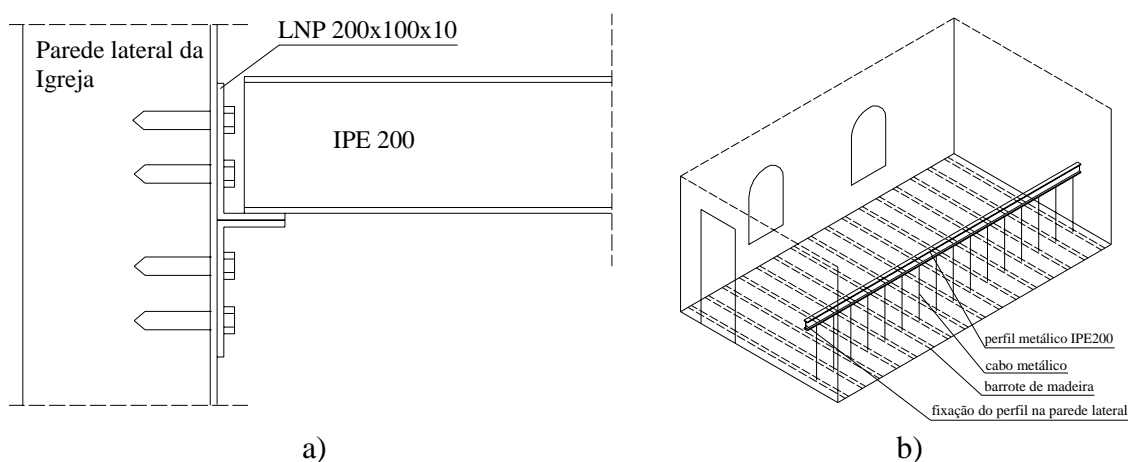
[4c]: a) Pormenor de ligação dos apoios da viga metálica provisória às paredes laterais; b) Esquema de suspensão provisório do pavimento do coro
